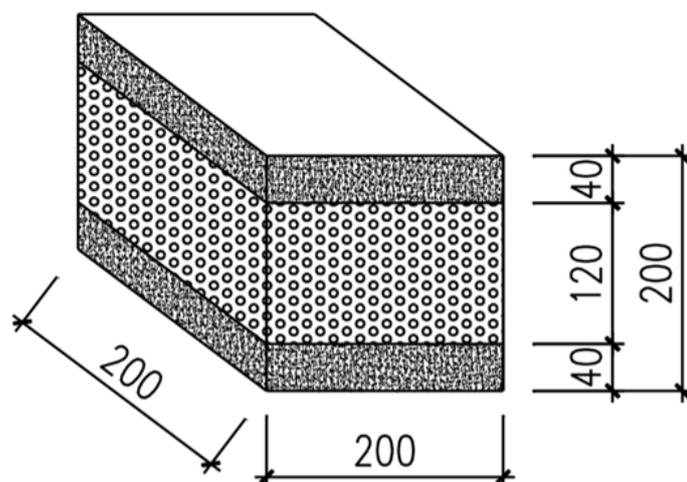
Тестовый образец трехслойной бетонной конструкции для испытания на сдвиг
